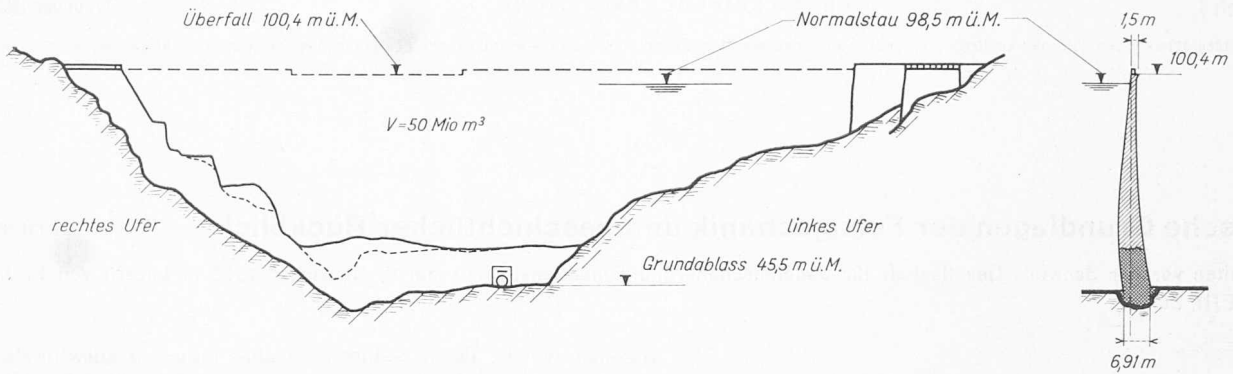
Staumauer Malpasset. Längs- und Querschnitt der Mauer mit den Überresten nach der Katastrophe. Masstab 1:2000
